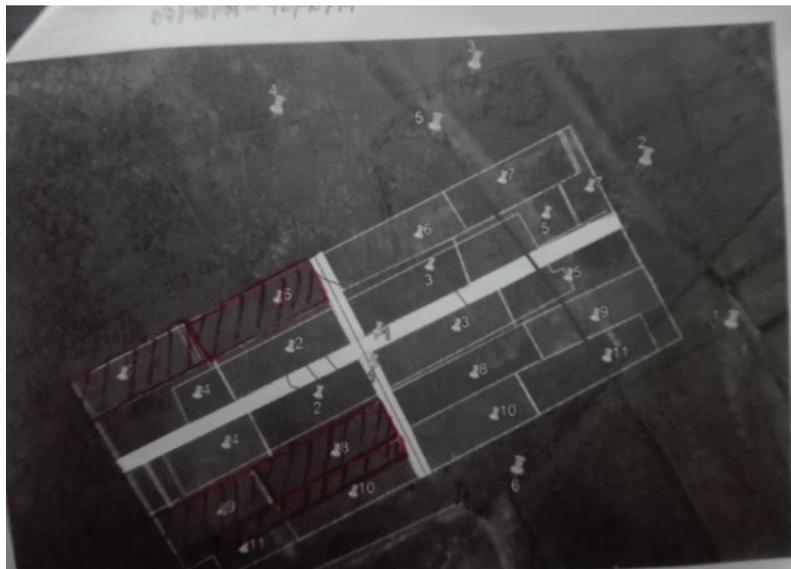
Planta de zonas para anexo del formato de excavación.
